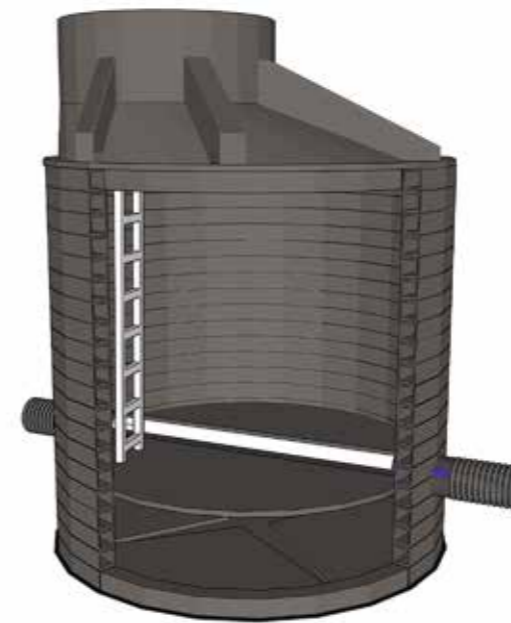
Типовой сварной канализационный колодец FD SVT
